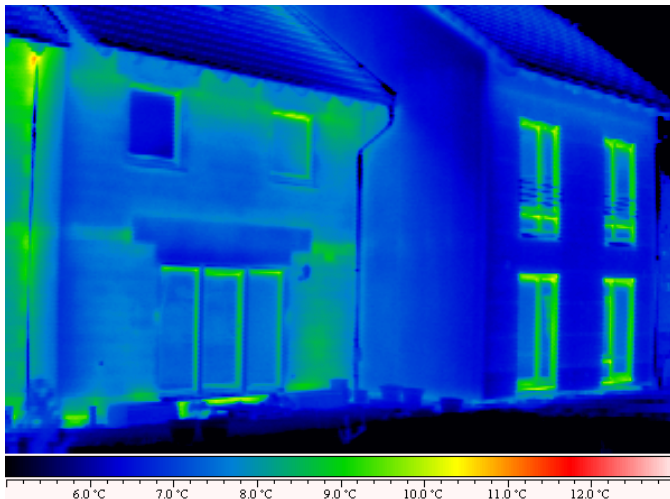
Zwei Gebäude nach modernem Niedrigenergiestandard, das rechte in innen gedämmter Holzständerbauweise, das linke erbaut aus hochdämmenden Mauersteinen mit abgedämmten Betonteilen.
